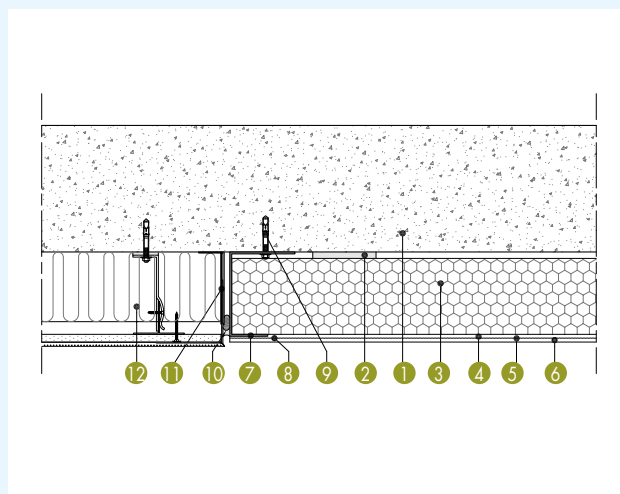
Raccordement avec d'autres systèmes d'isolation (coupe horizontale)
